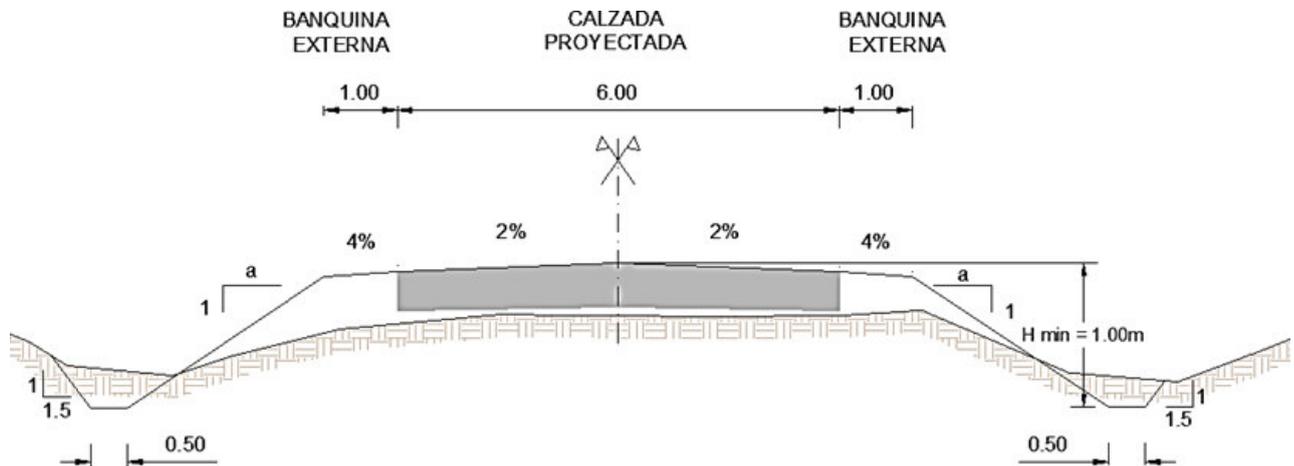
Perfil tipo de obra básica entre PR 0+000 – PR 1+925
